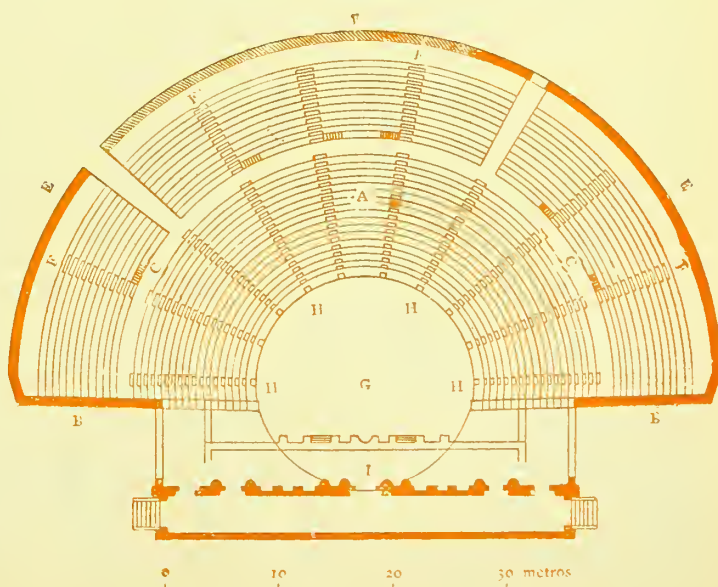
PLANTA DEL TEATRO DE SEGESTO
